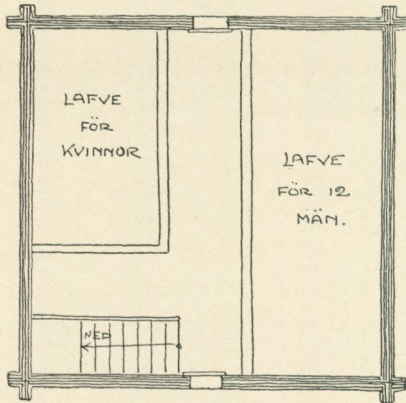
b. Plan af öfre våningen af slätterbastun.
